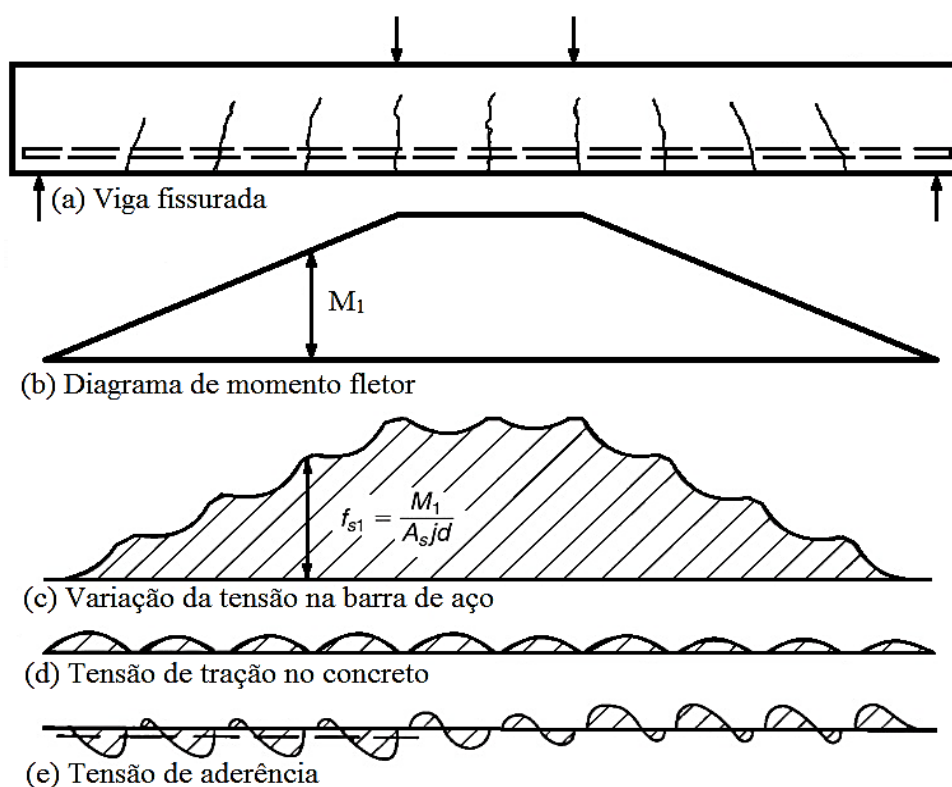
Aço, concreto e tensão de aderência em uma viga - MacGREGOR (2012).
